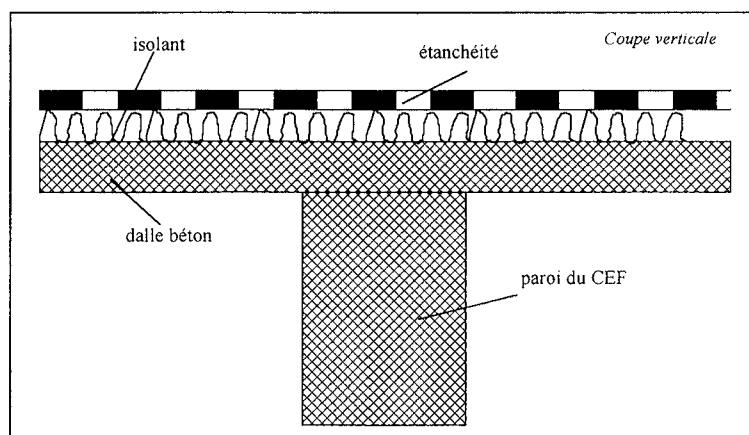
a : Cas d'une toiture-terrasse en béton armé : coupure de la toiture non nécessaire.
